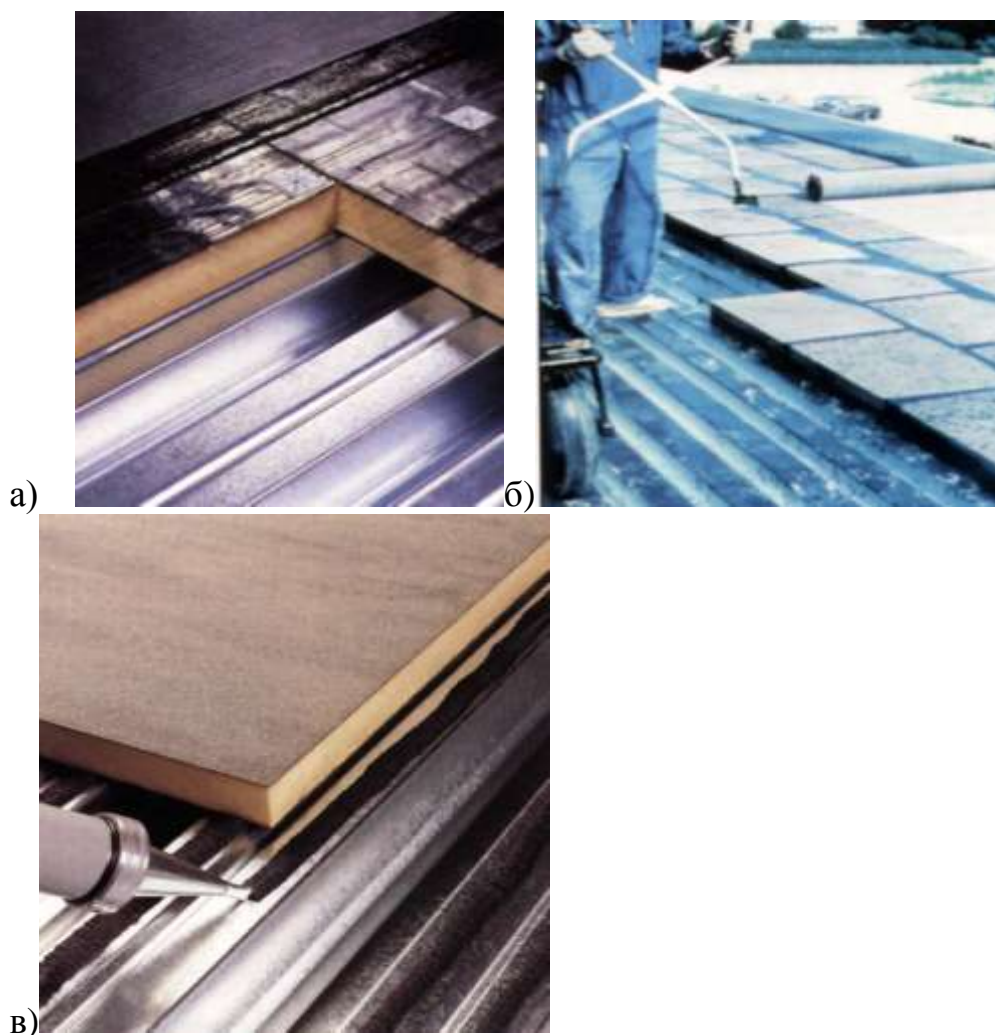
Укладання жорстких теплоізоляційних плит на основу із профлиста:
